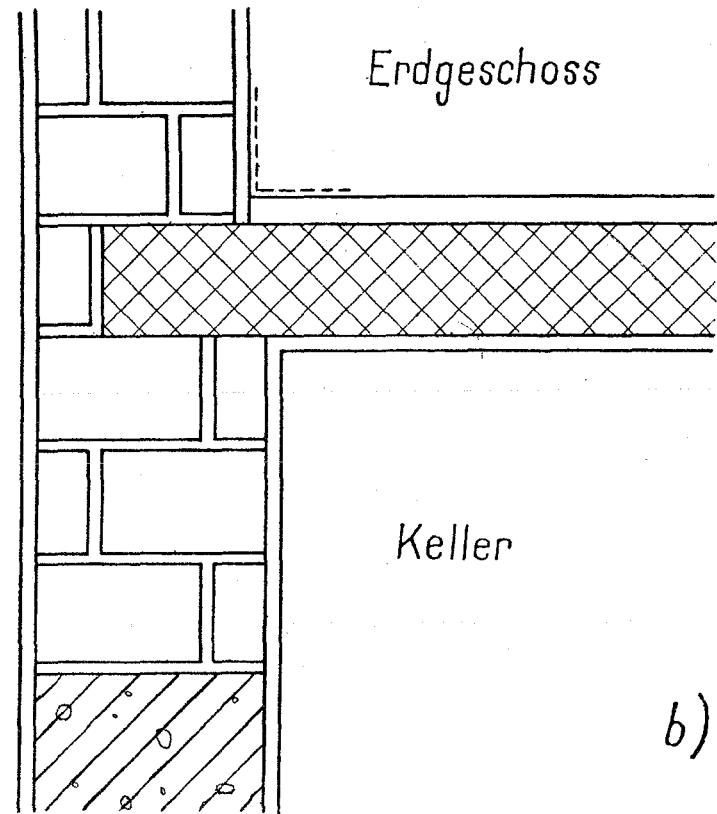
Wärmebrücken. Durch die Betonmauer fließt die Wärme aus der aufgelegten Decke und dem aufgehenden Mauerwerk stärker ab. Folgen: Kondenswasserbildung längs der gestrichelten Linien (a). Abhilfe durch teilweisen Ersatz des Betonmauerwerkes z. B. durch Backsteinmauerwerk (b).
